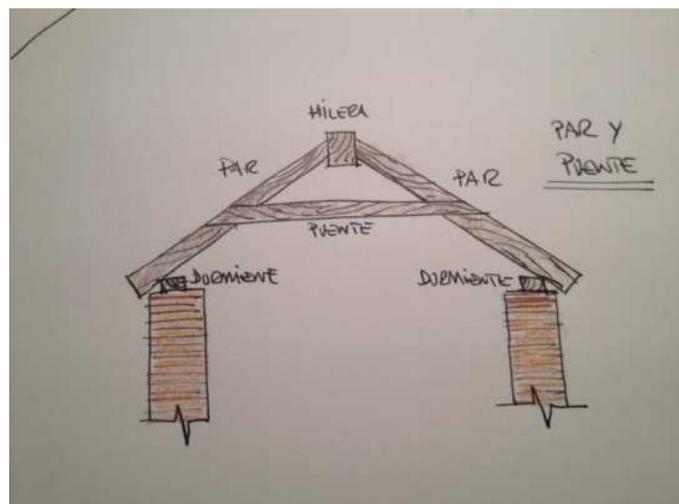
Detalle de cubierta de par y puente. (MARÍN)
